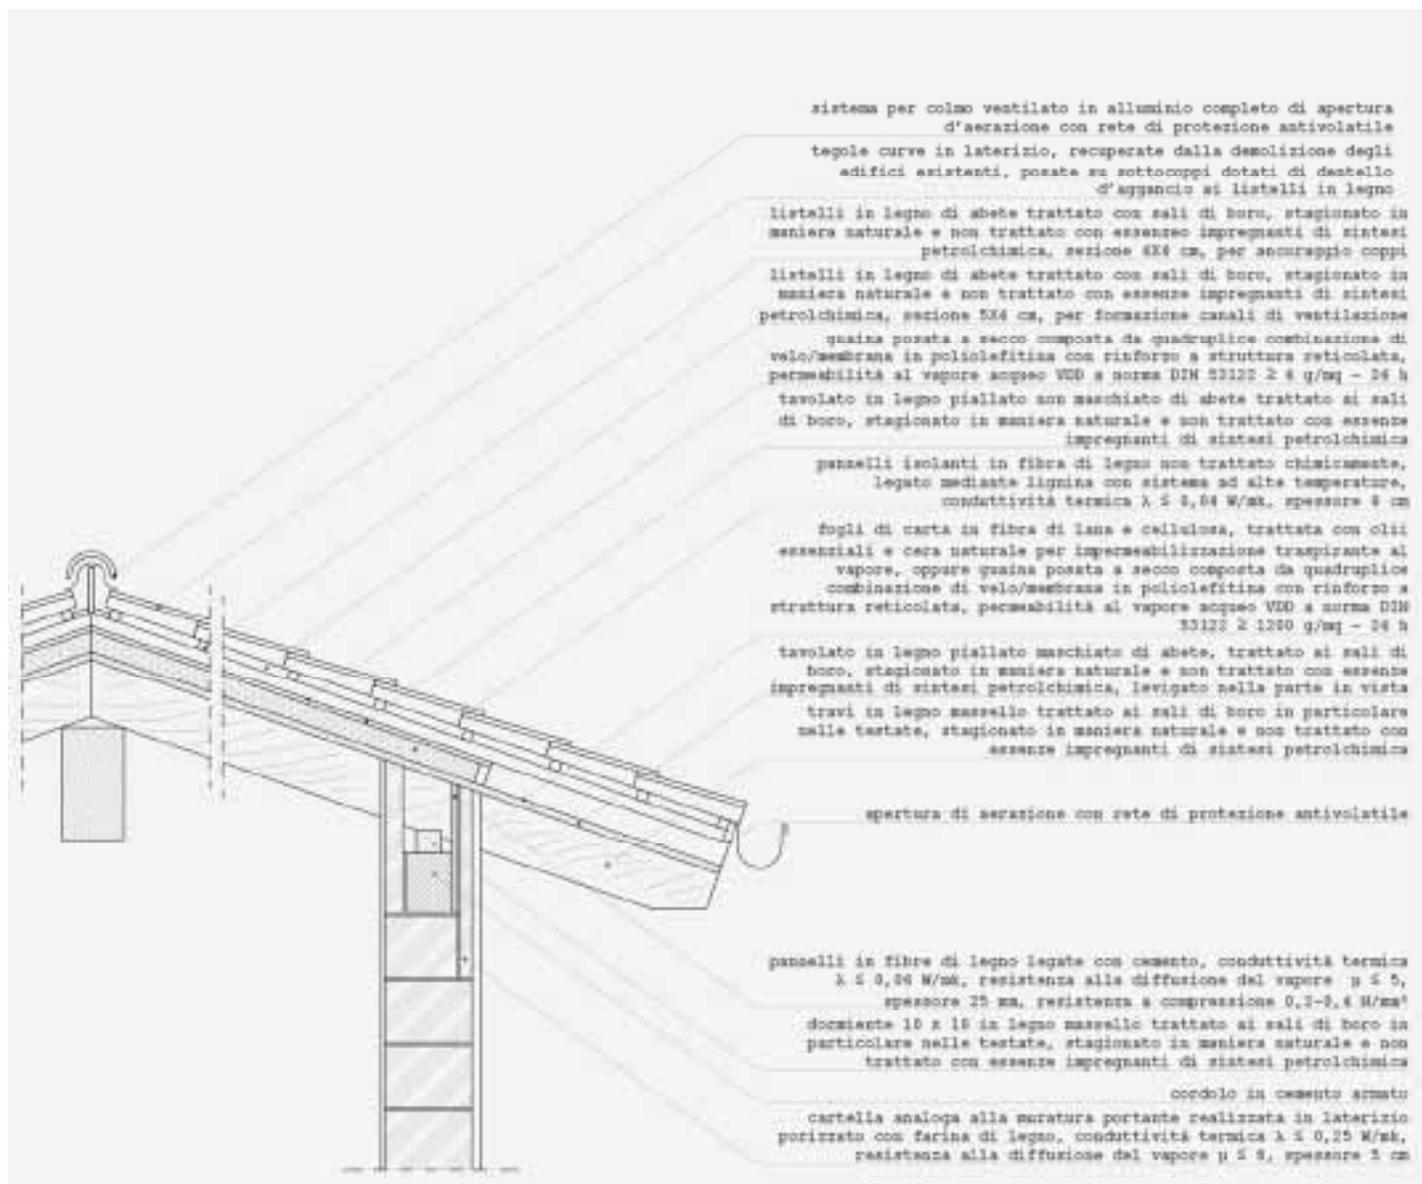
Schema copertura ventilata proposto nel progetto esecutivo.
